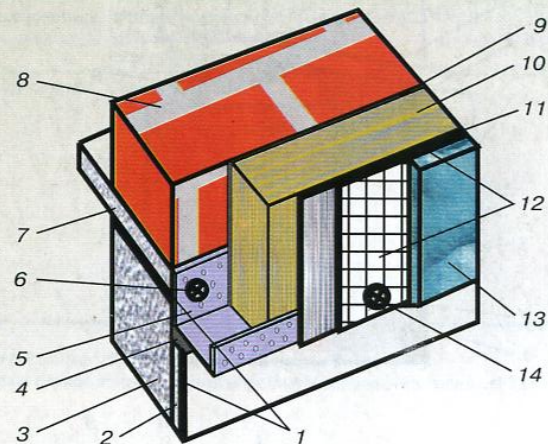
ФРАГМЕНТ УТЕПЛЕННОГО ФАСАДА:
